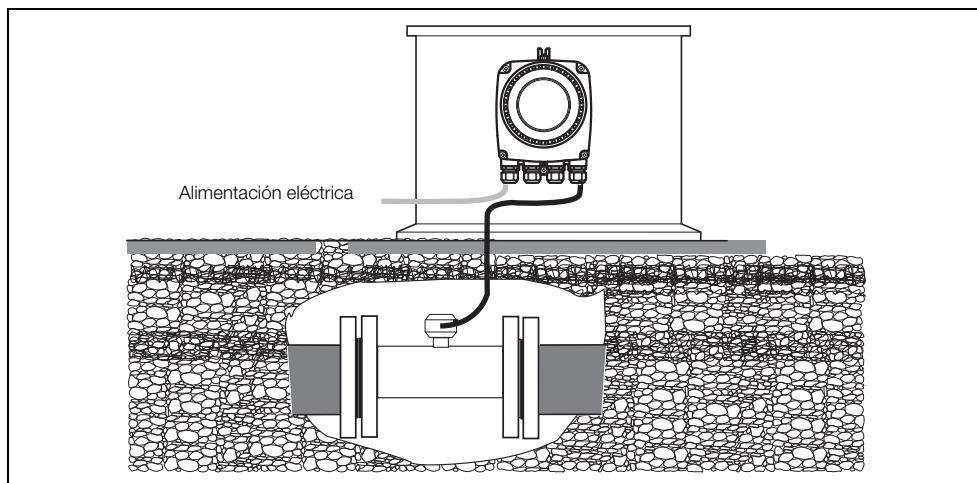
Transmisor remoto en cabina al borde de la carretera
